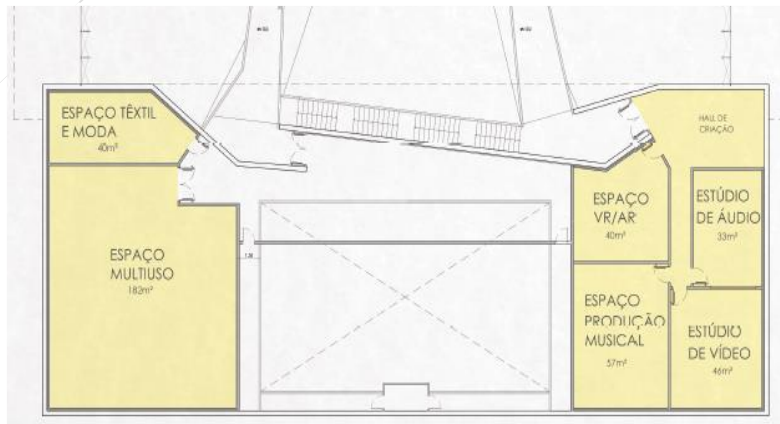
º Pavimento Anteprojeto para segunda fase de implantação
